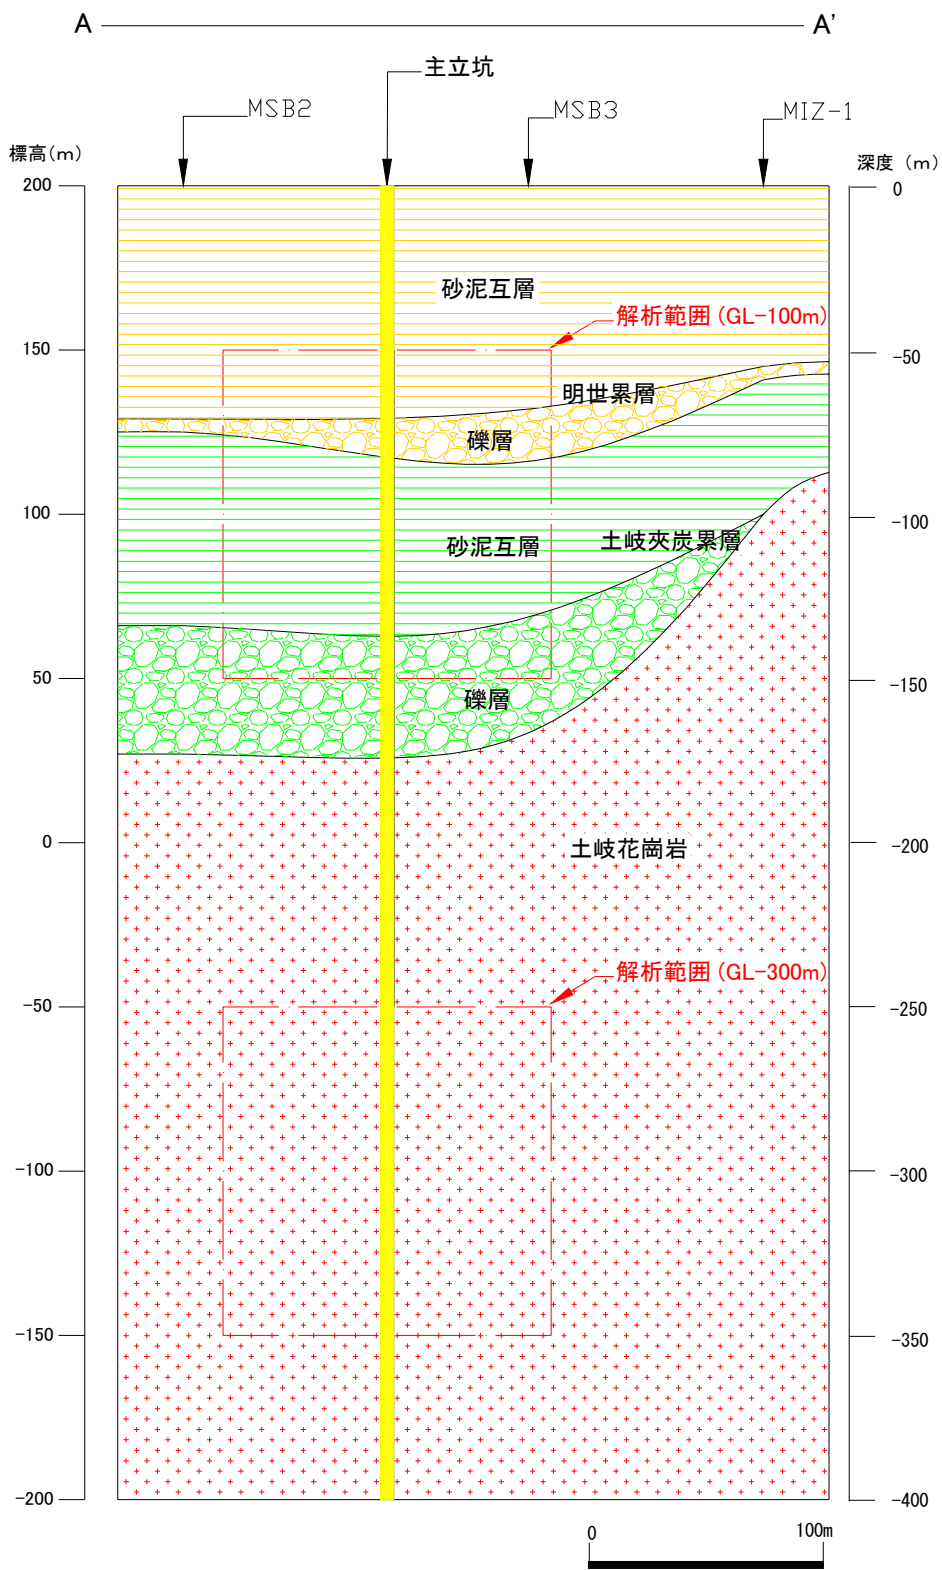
立坑近傍の断面図 (平面図中の A-A' 断面)
